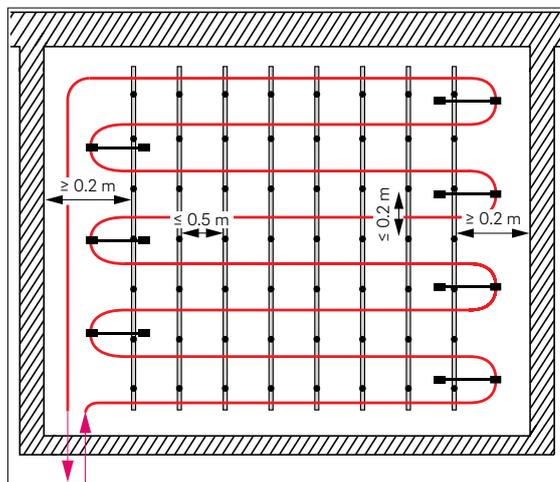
Einfachmäanderförmige Ausführung, VA 10 (Ansicht Wandfläche)
